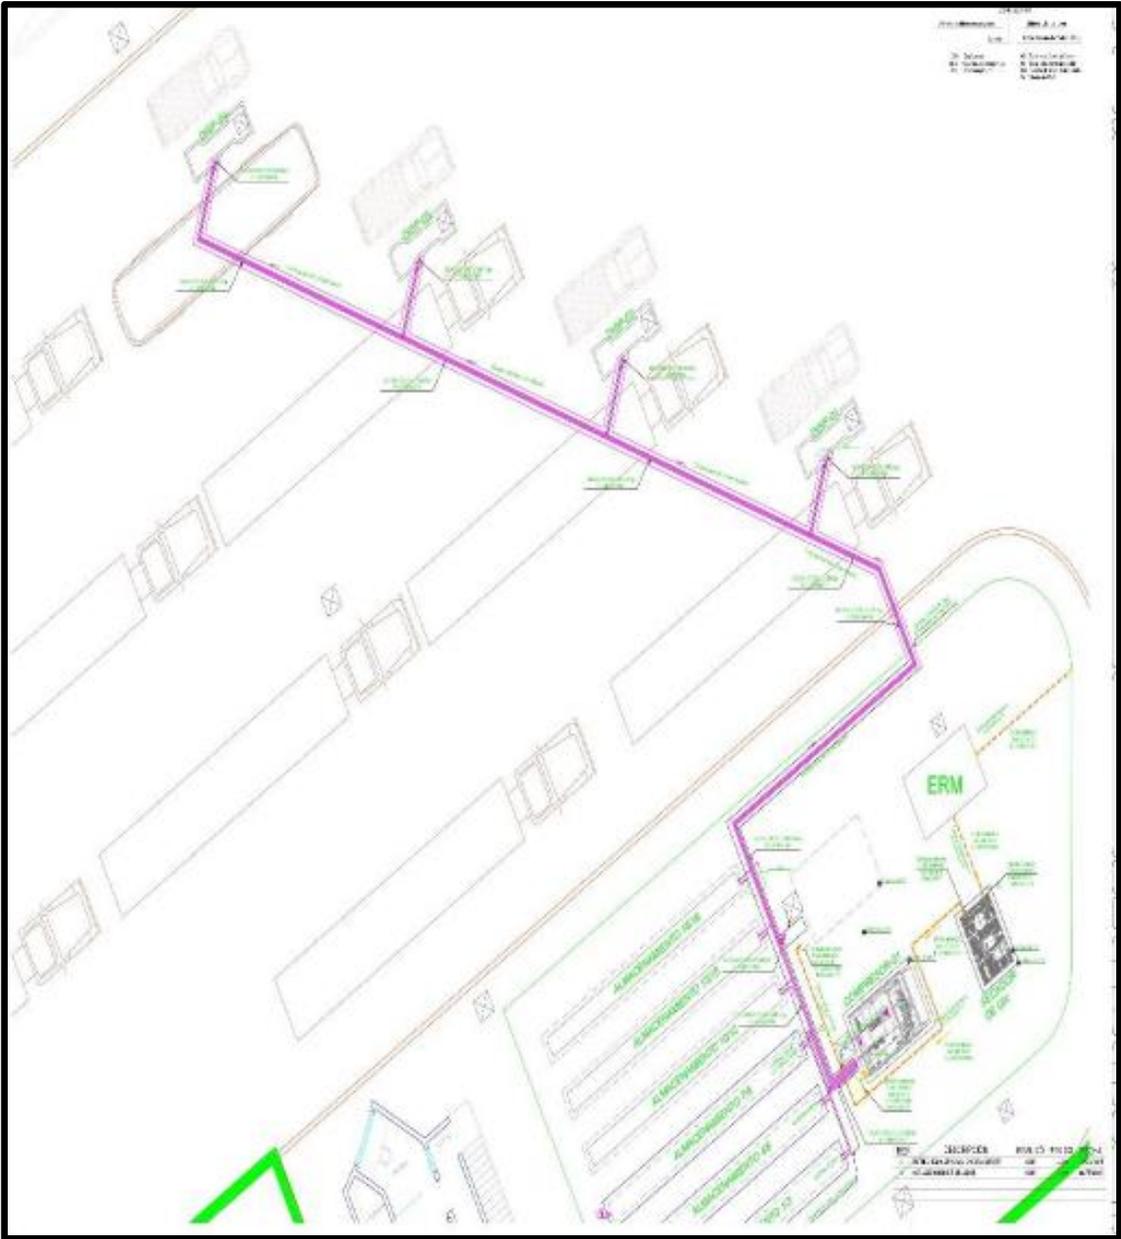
Plano de las distintas secciones de la planta de distribución.
